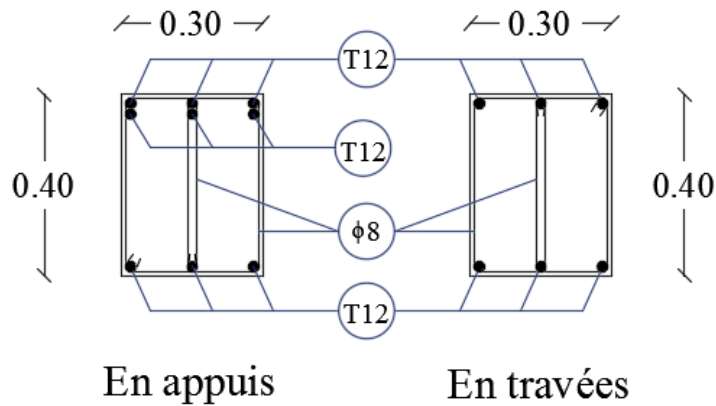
Ferrailage des poutres principaux (bloc 1/2/3)
